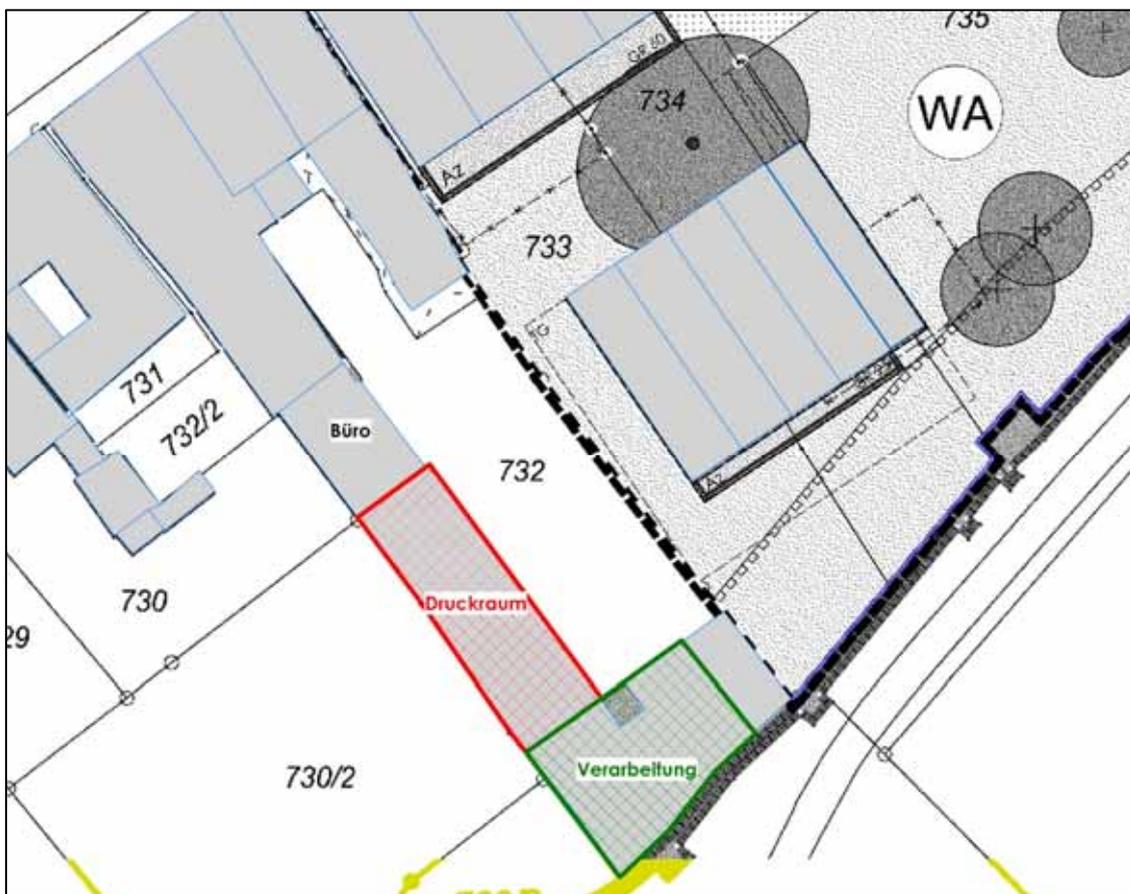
Lageplan mit Kennzeichnung der Betriebsgebäude der Druckerei
